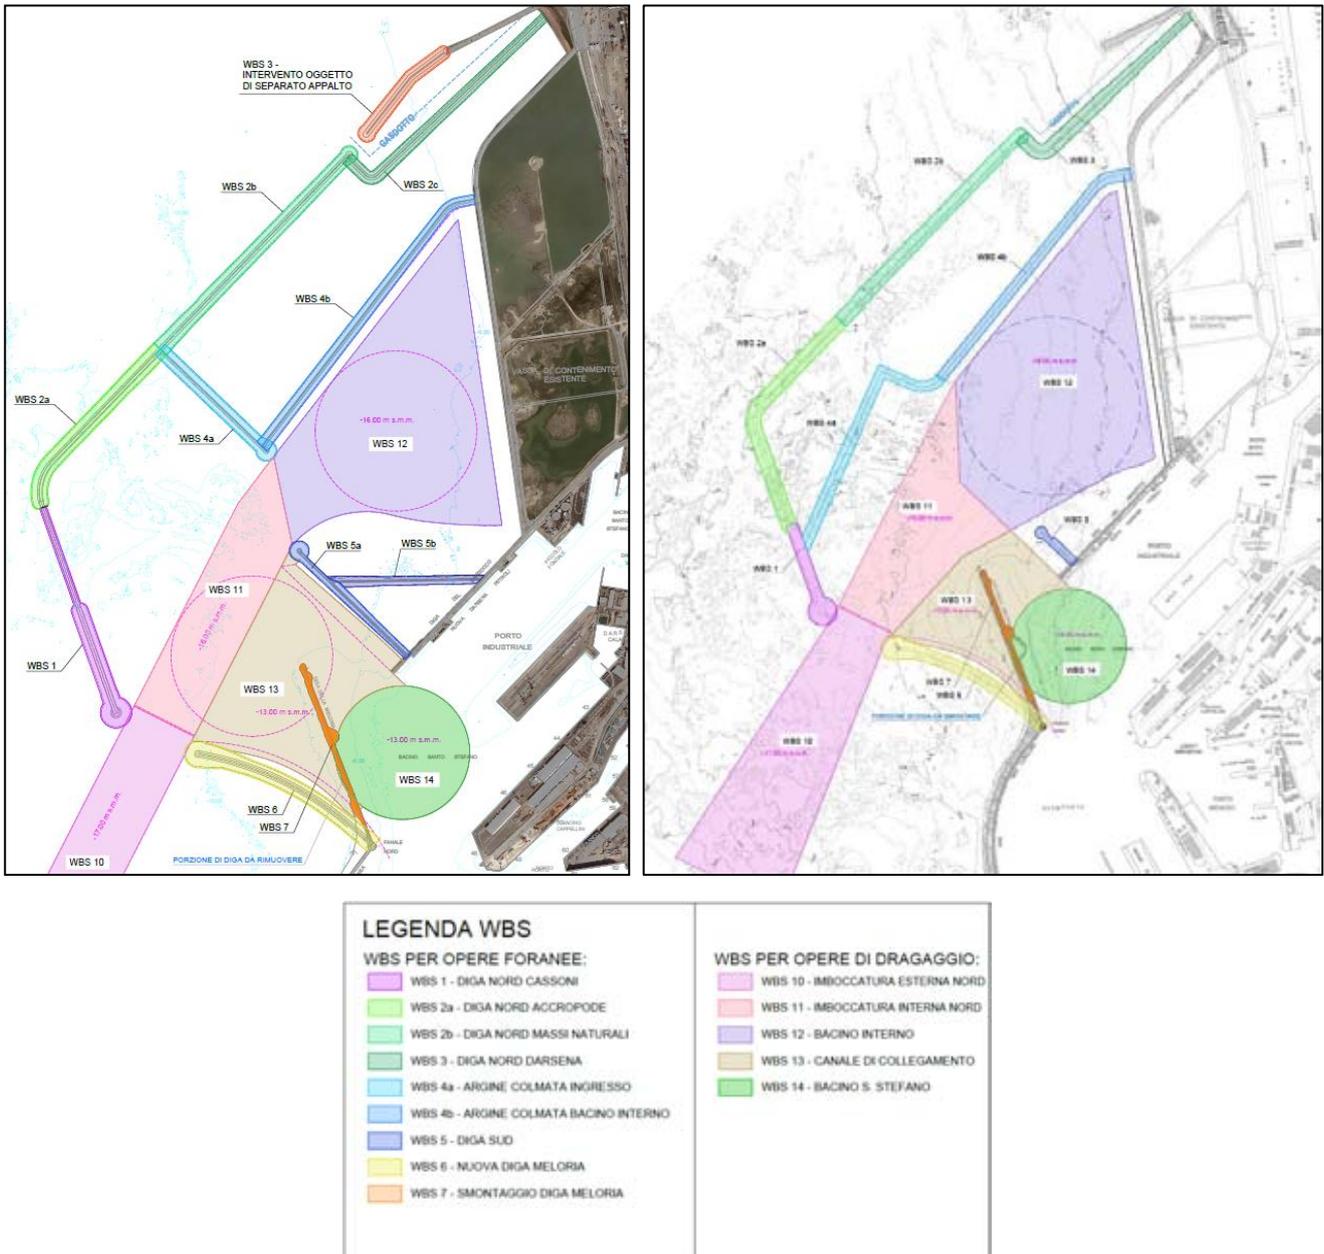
Confronto tra layout del PTFE e layout del Progetto Definitivo
